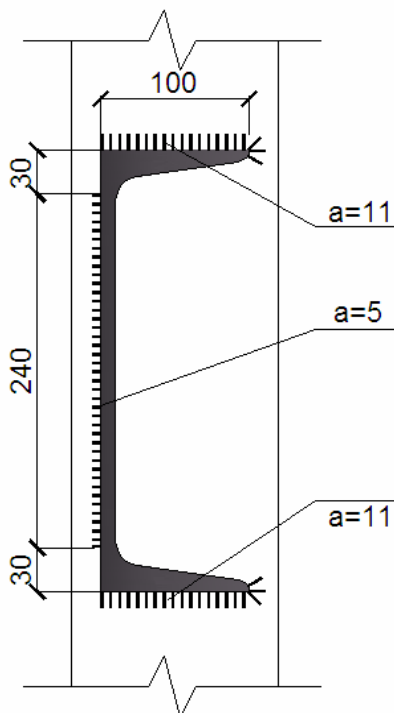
Dimensiones relevantes en los cordones de soldadura para comprobar los requisitos relativos a las disposiciones constructivas
